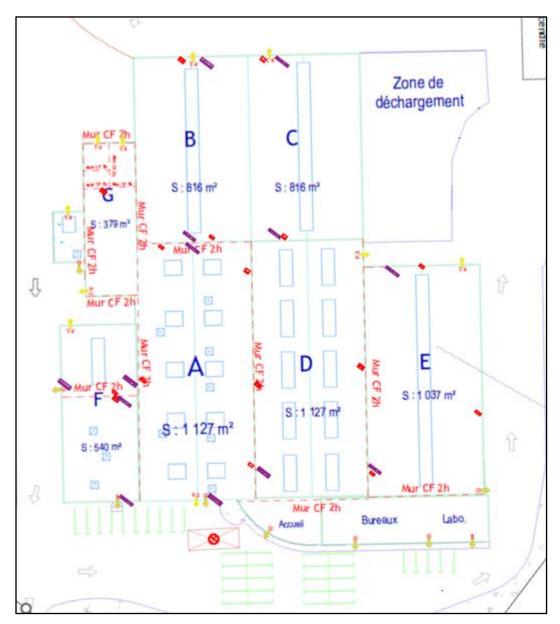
Localisation des murs coupe-feu bâtiment existant (source : sicabconstruction)
